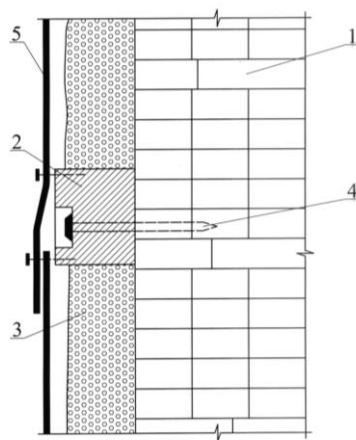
Утепление фасада плитным утеплителем по деревянному каркасу: 1 – утепляемая стена; 2 – брусок каркаса; 3 – утеплитель; 4 – анодированный или оцинкованный анкер; 5 – лист облицовки
